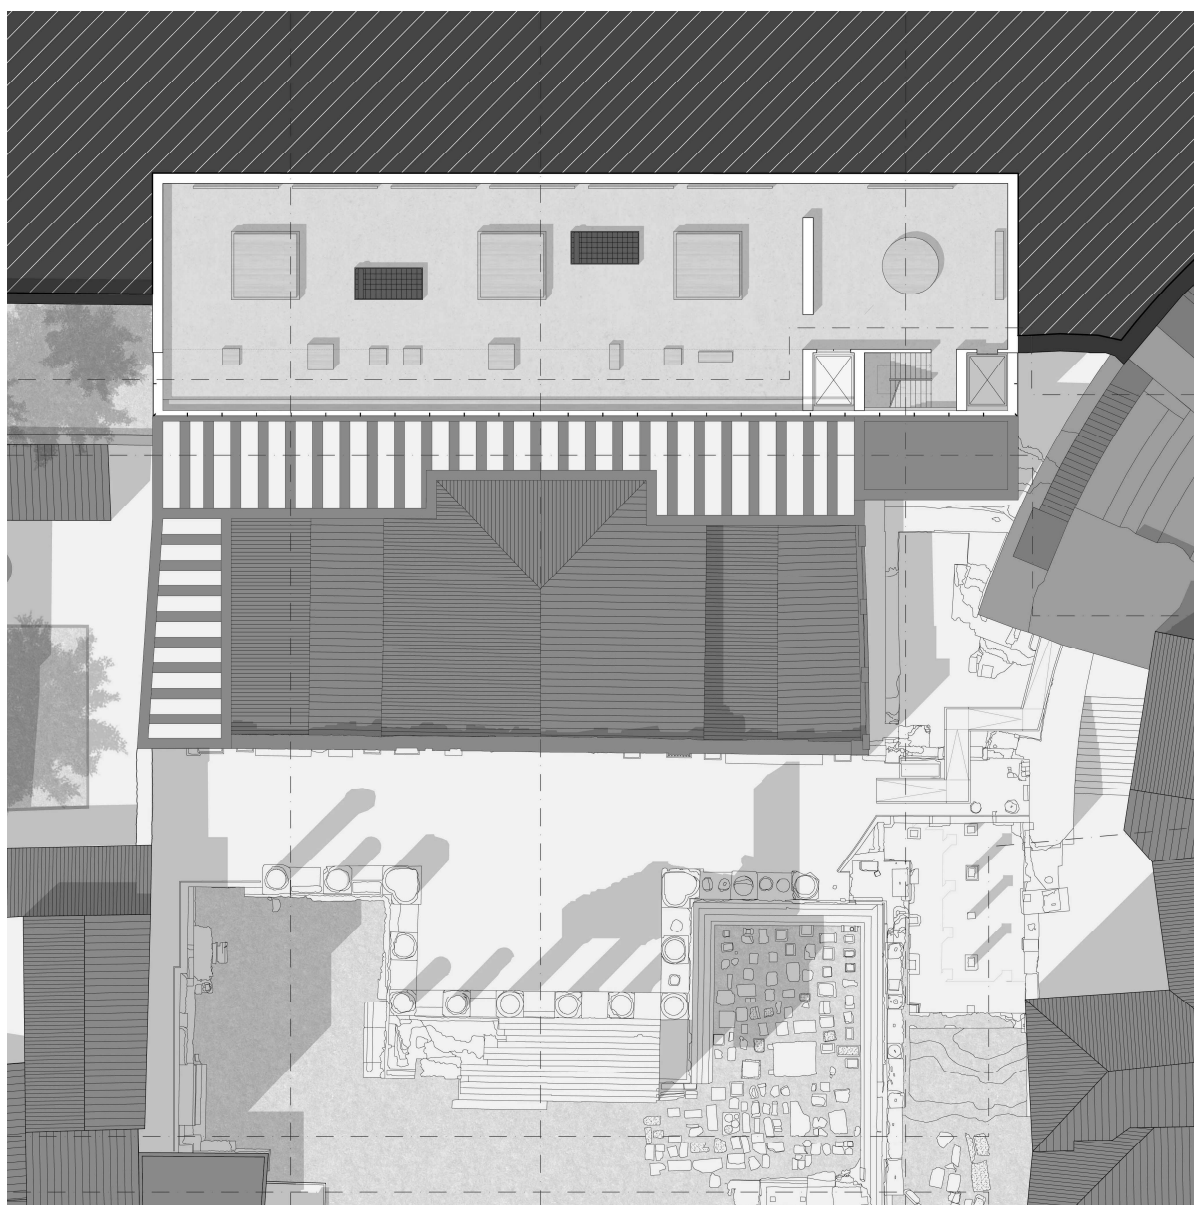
Pianta del piano secondo dell'edificio di progetto posto alle spalle del Capitulum
